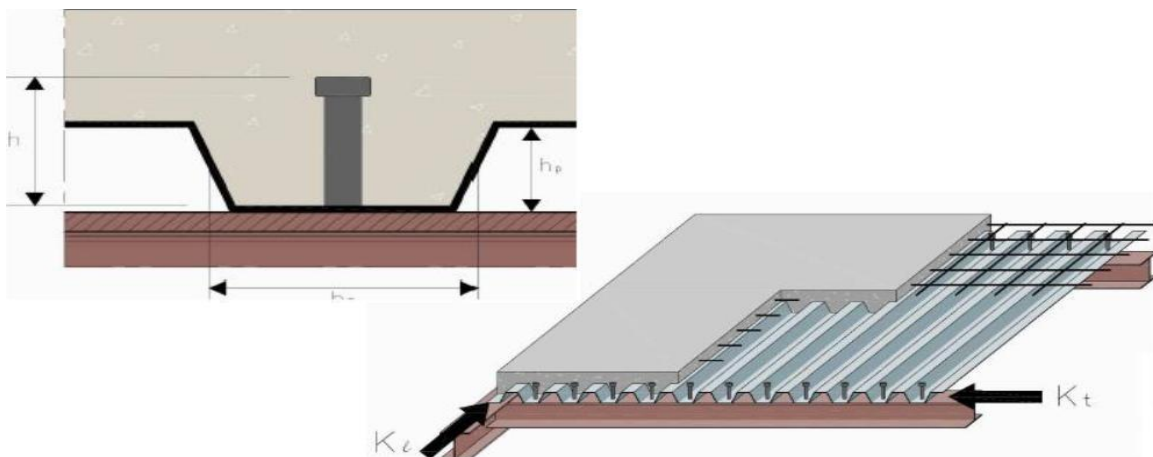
Goujons à tête soudés en présence d'une dalle mixte à bac collaborant.
